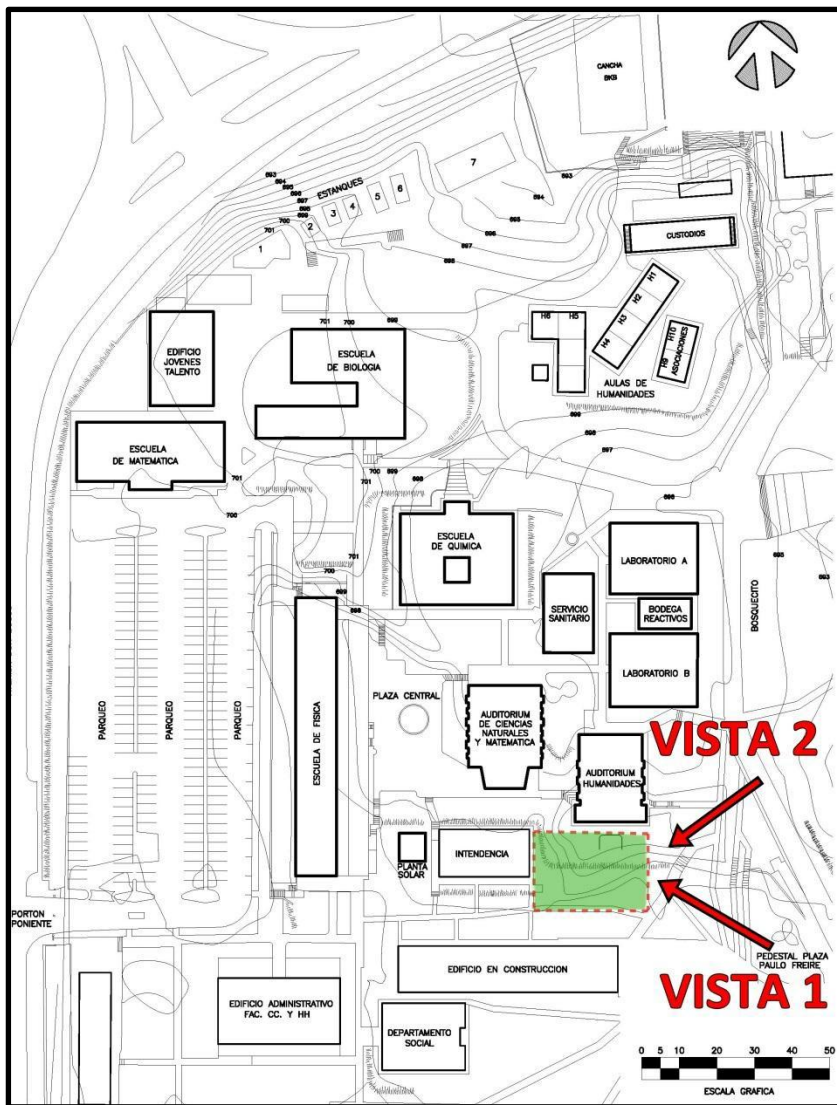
PLANO DE UBICACIÓN DE TERRENO ALTERNATIVA No. 3
